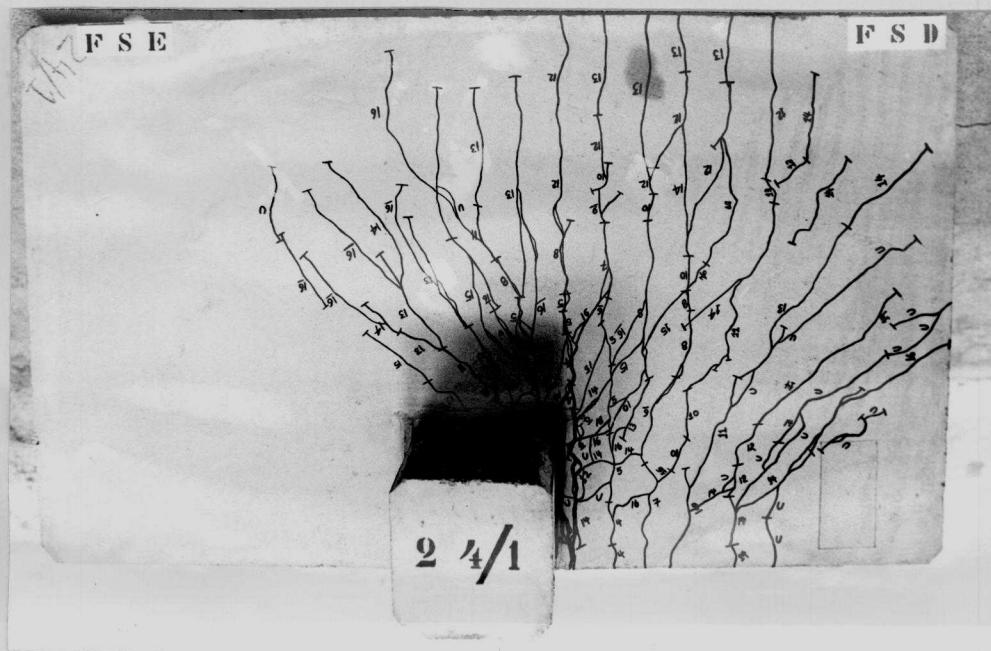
a - Fissuração na face superior do modelo EdL 24/1.
